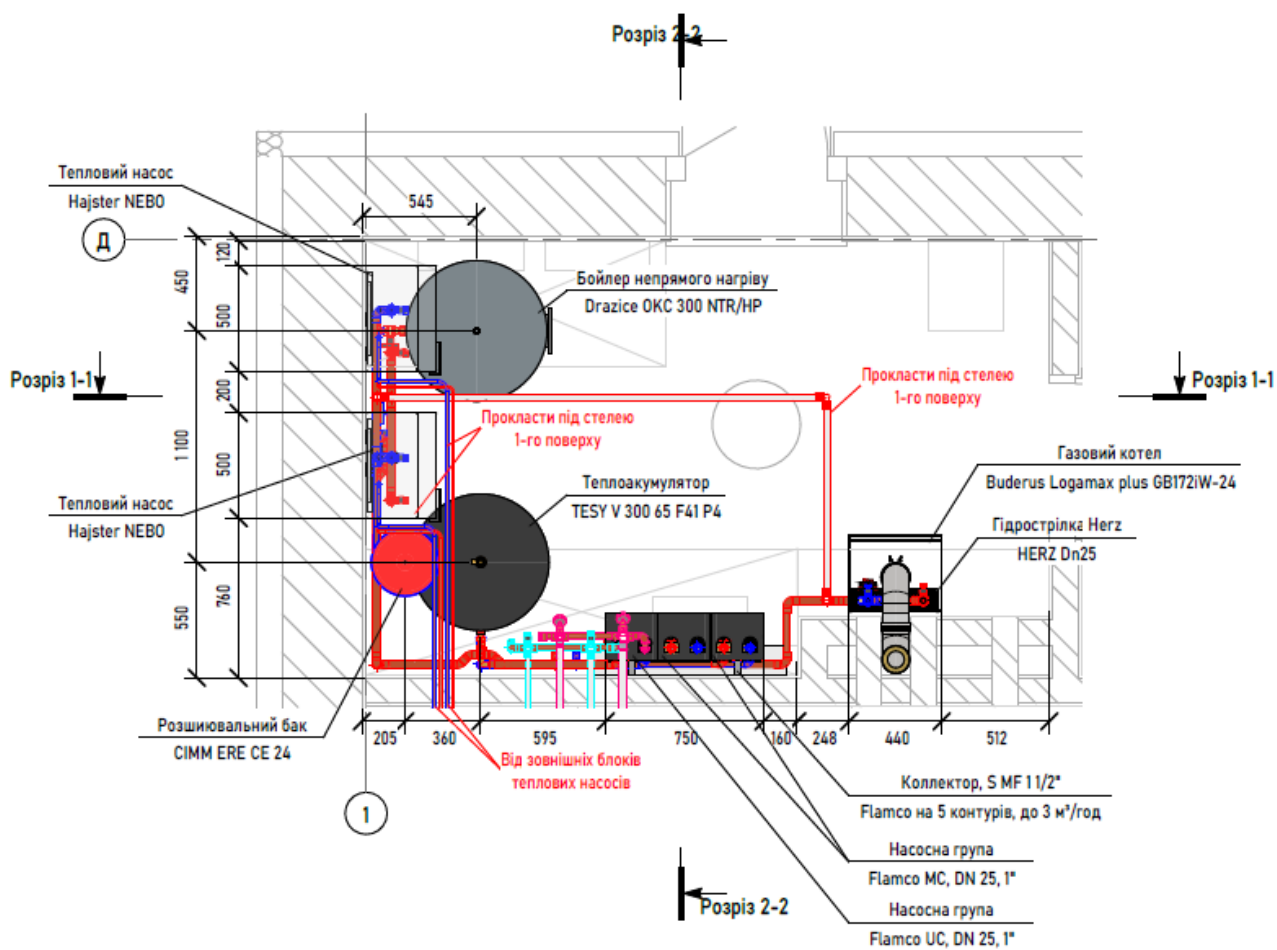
План котельні 1-го поверху. Ч1
